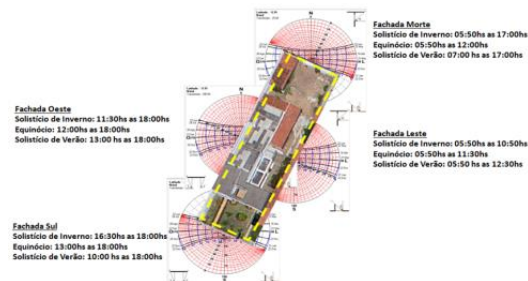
Análise geometria solar das fachadas da edificação A - UNIMED
